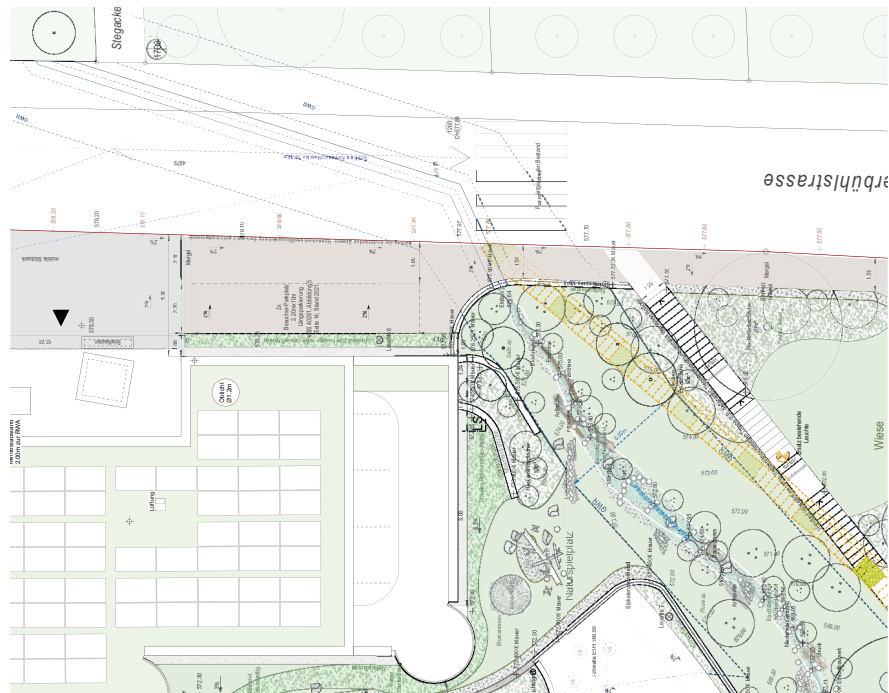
Ausschnitt Baueingabeplan Freiraum, Stand September 2025
